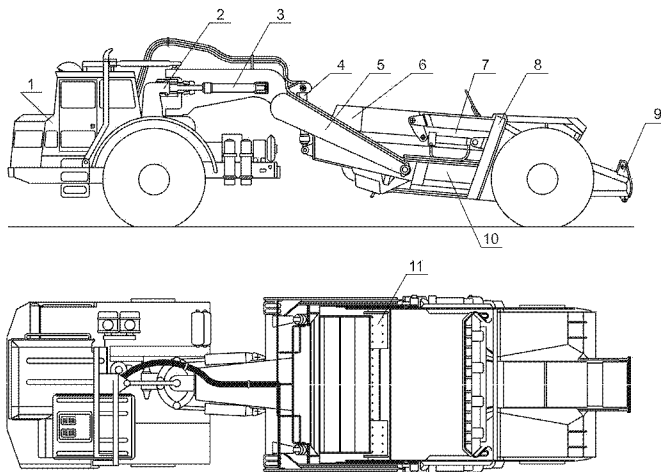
Конструктивная схема самоходного скрепера:
